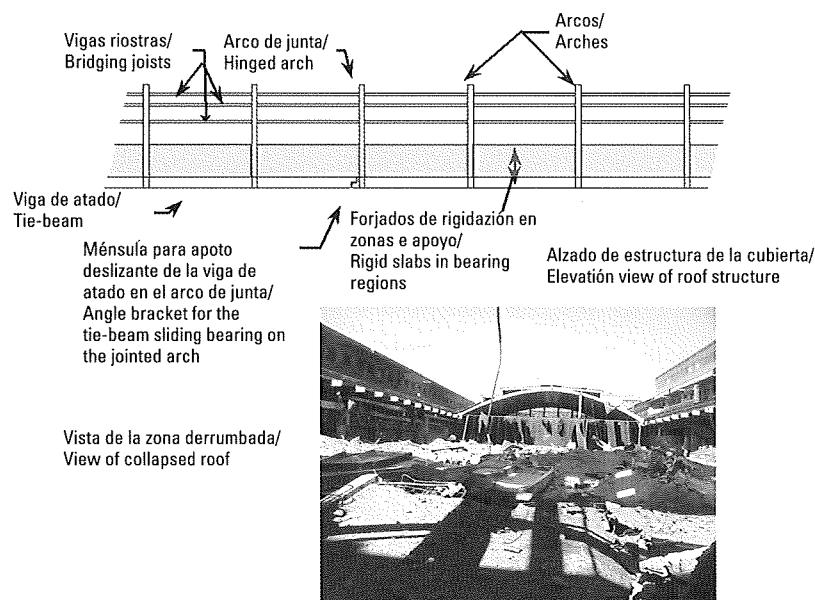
a). Arco de hormigón prefabricado con vigas y correas también prefabricadas.
